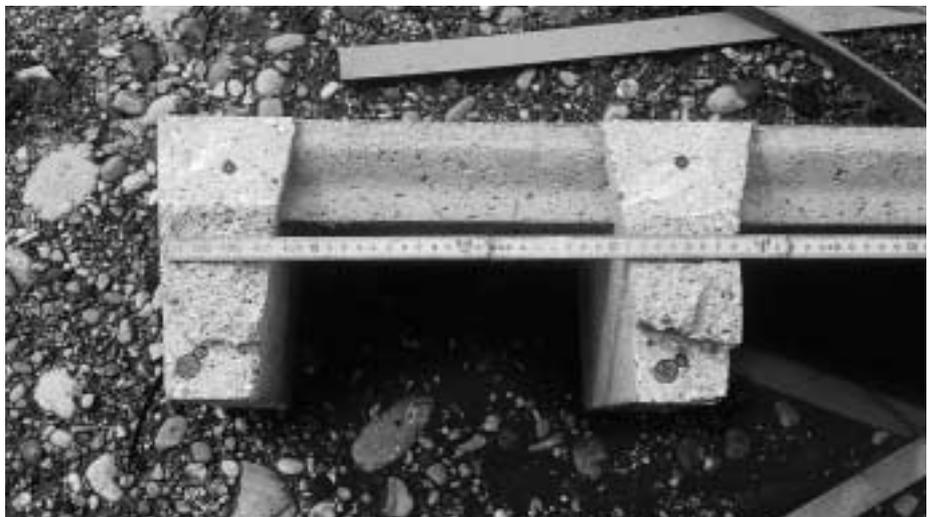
Ungenügende Betonüberdeckung bei einem neuen Flächenrost.
